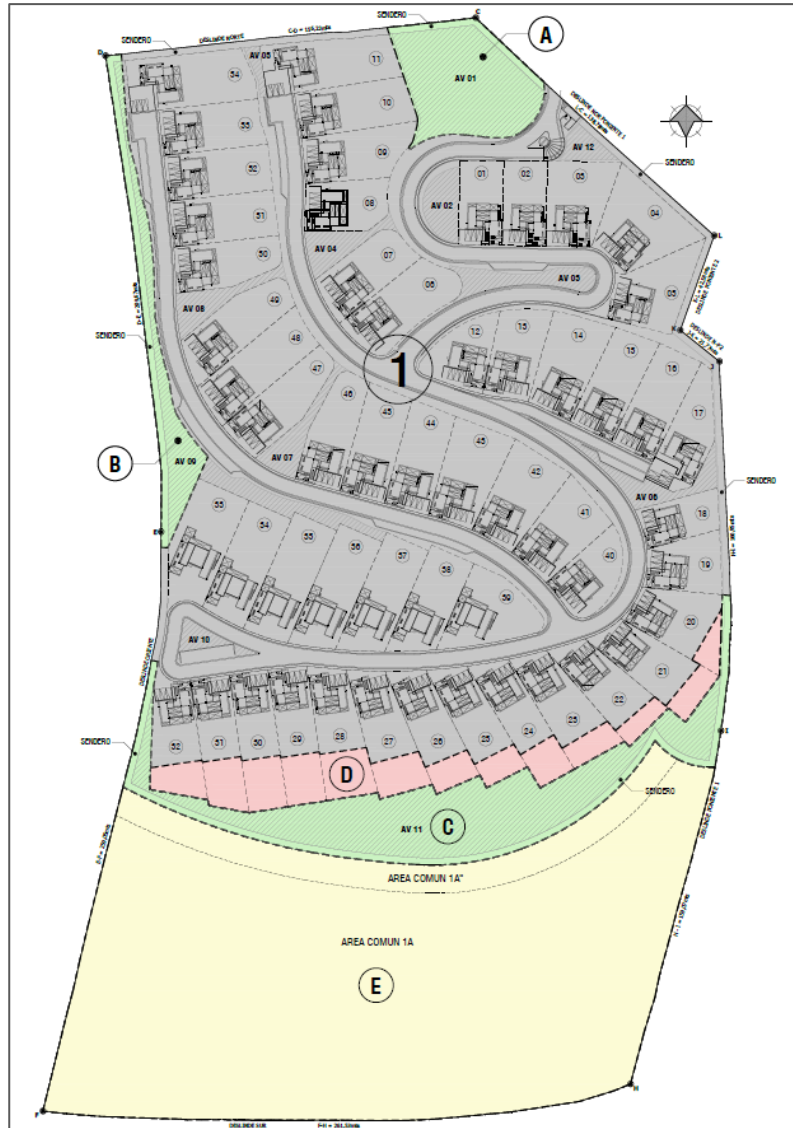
Levantamiento original DECON UC (“DUC-2203-LT-v5” correspondiente al plano de la Modificación Permiso de Edificación N°037/2018)
